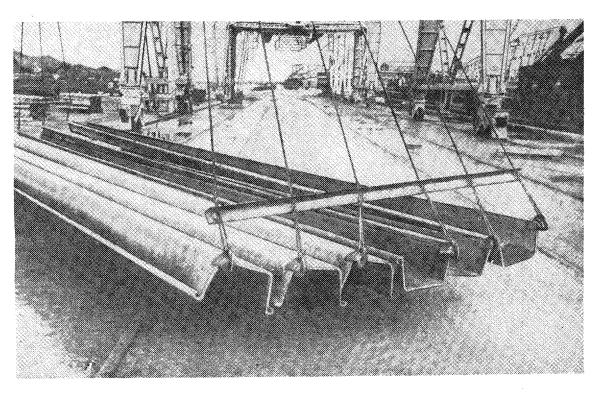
I. Поштучная перегрузка шпунтовых свай с помощью крановой подвески с захватами. Порт Ильичевск
